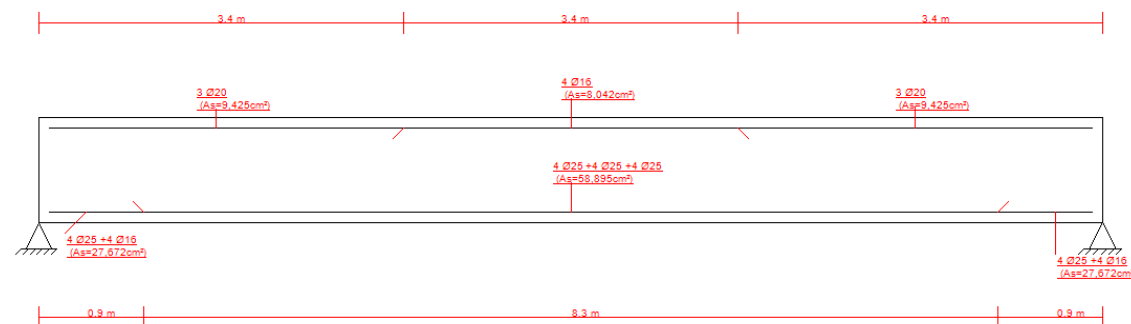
Pormenorização da armadura longitudinal solução (c)
